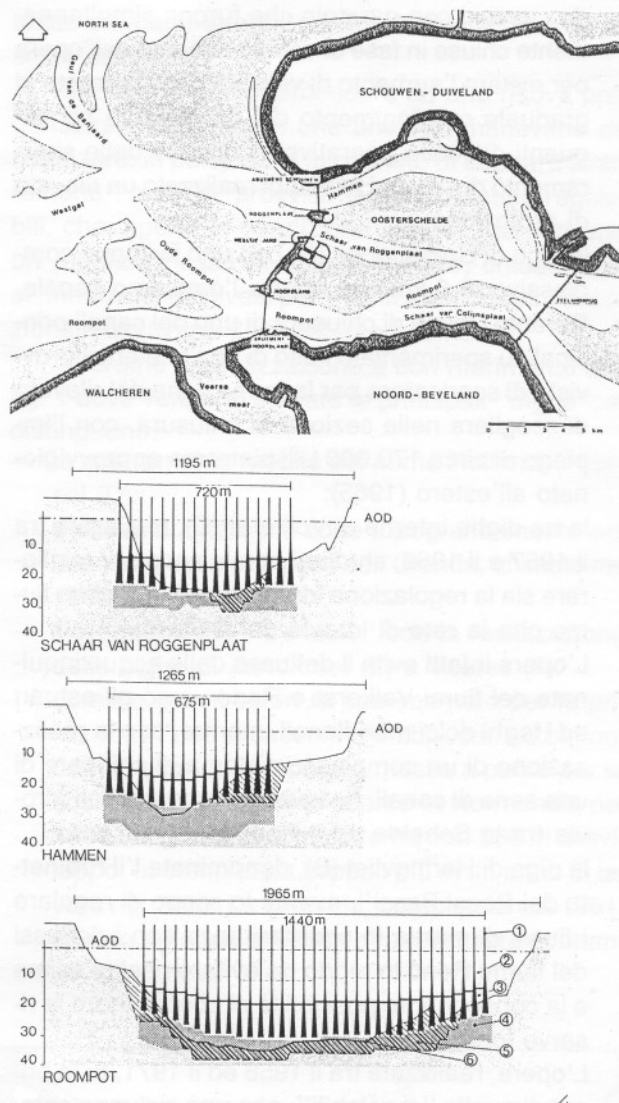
Planimetria della bocca dell'estuario orientale dello Schelda sezione dei tre canali di marea con le opere di sbarramento
